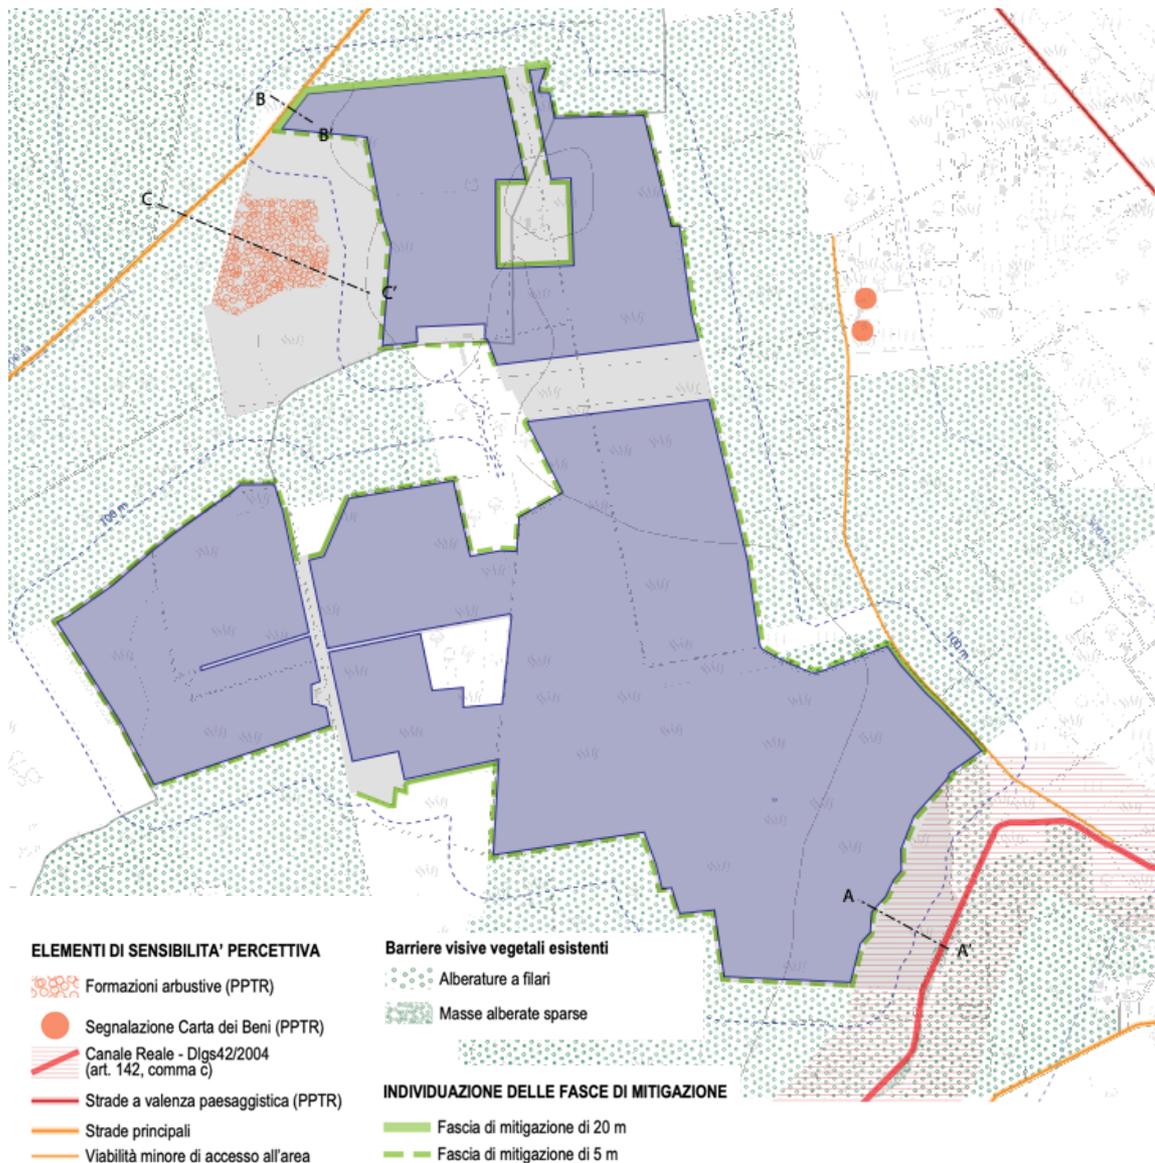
Planimetria di individuazione delle fasce di mitigazione
